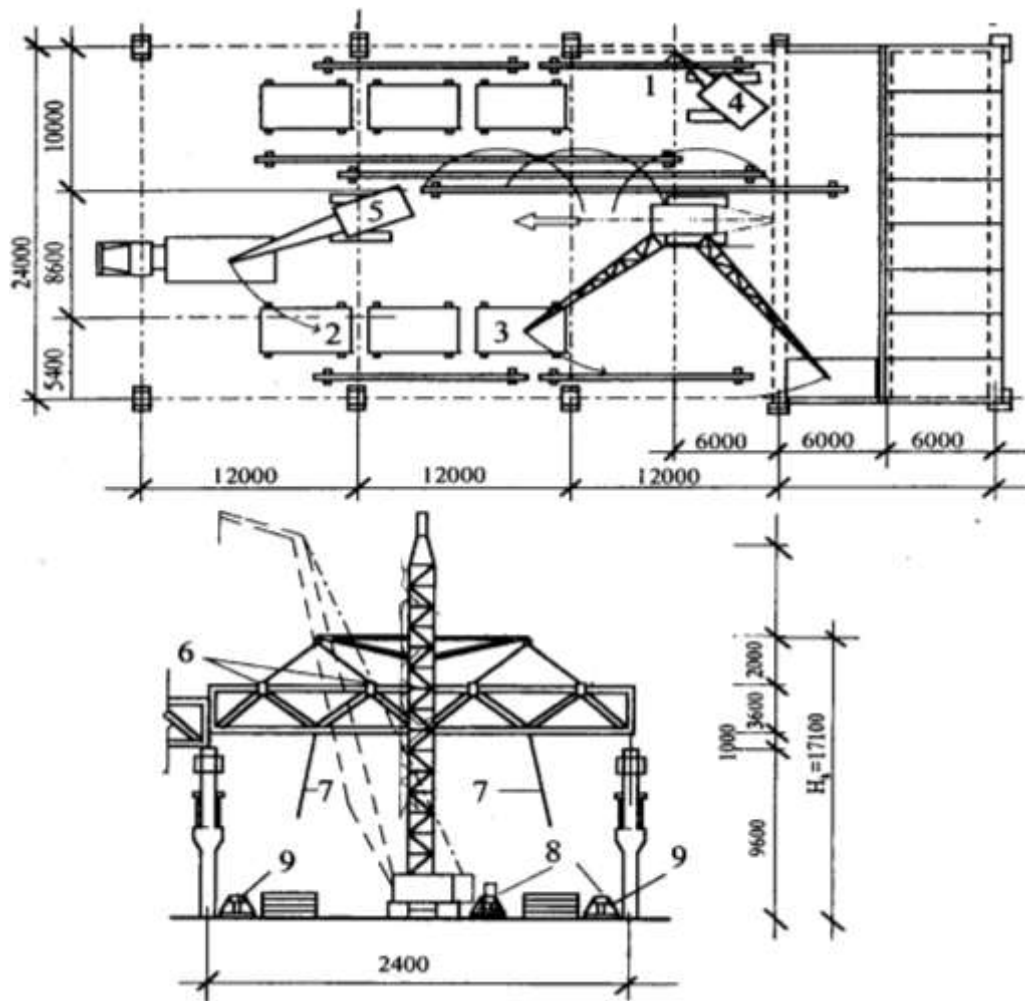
Схема розкладання та монтажу конструкцій покриття одно етажного промислової будівлі:
